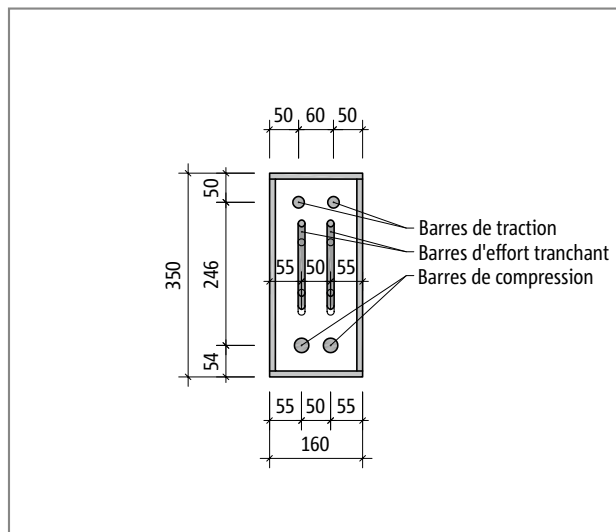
Schöck Isokorb® T Type B-M1-V1 en hauteur H350 : Vue du produit
